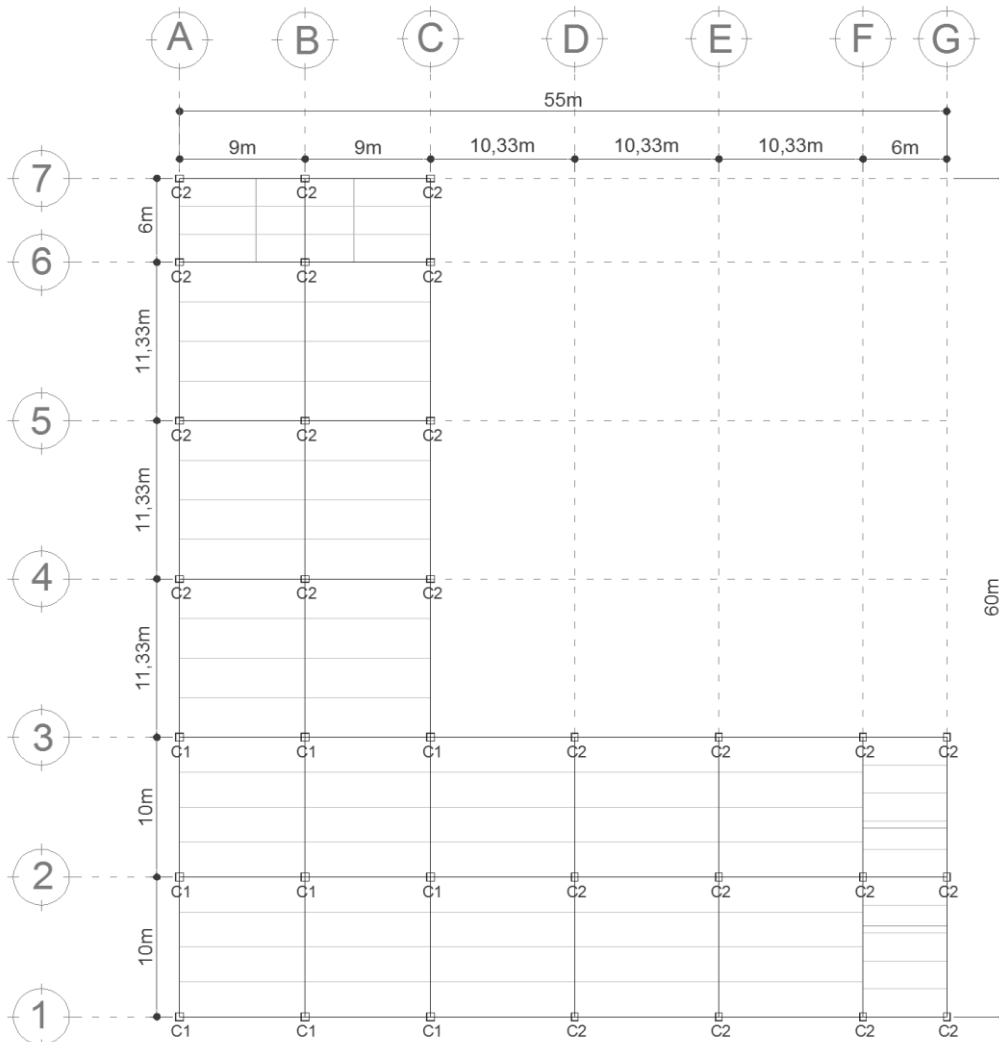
Columnas propuestas del nivel 1 al 5 para la estructura de acero.
